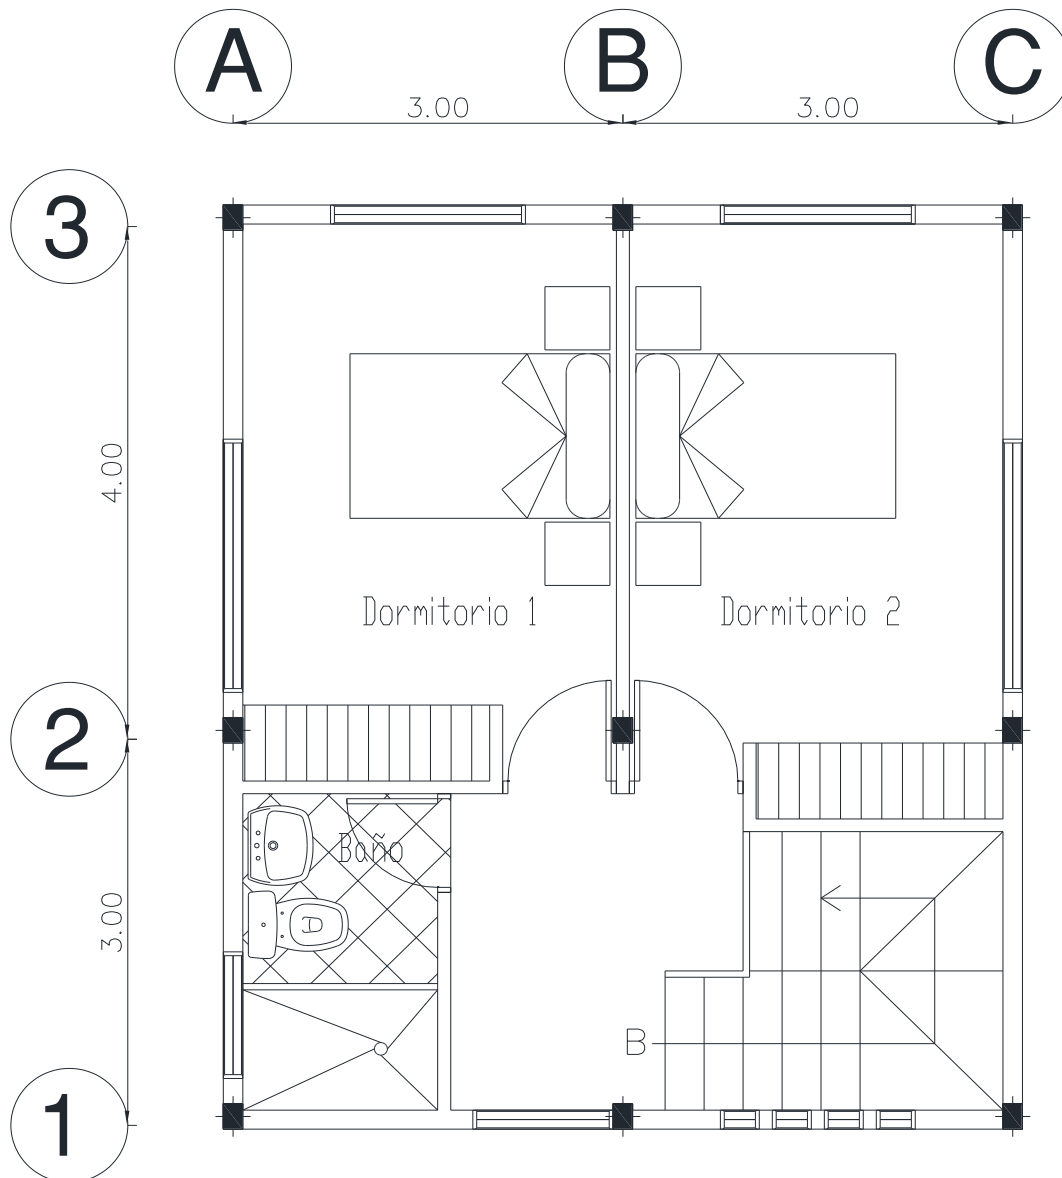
Distribución arquitectónica de planta baja
